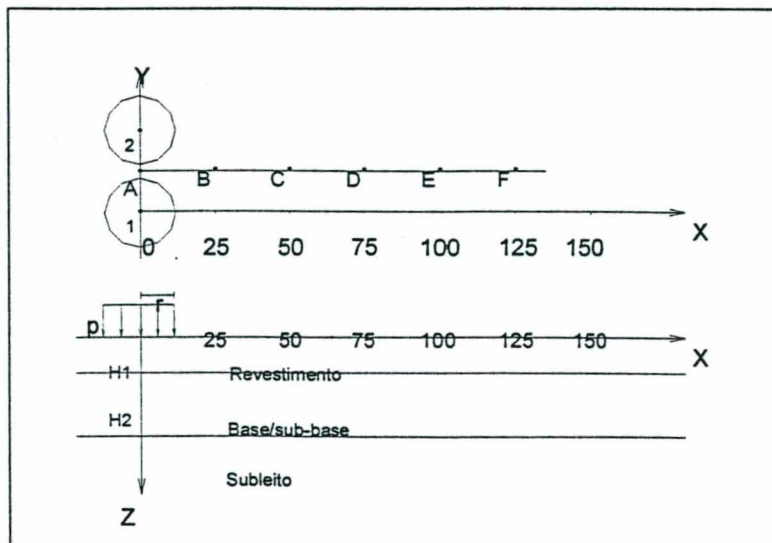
Pontos de avaliação da Viga Benkelman.
